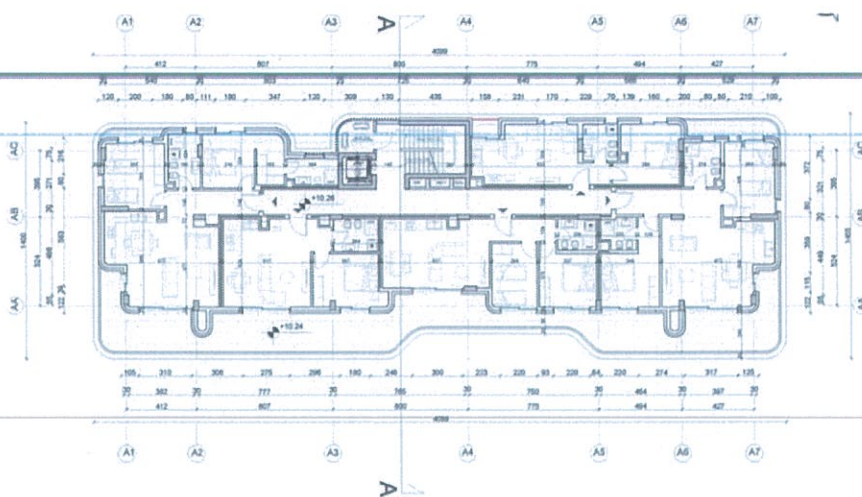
Planimetria e katiit tip Apart-Hotel (Objekti A).
